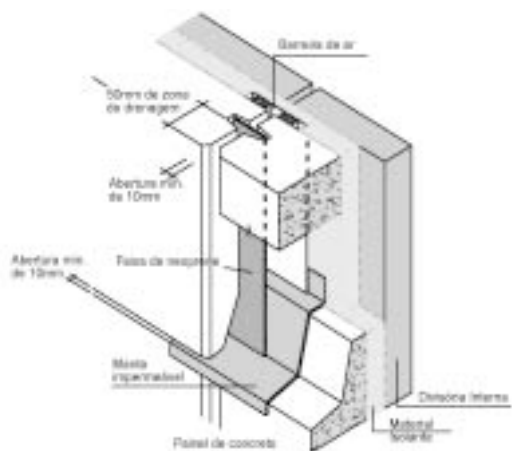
Detalhe de junta aberta e drenada com faixa vertical de neoprene (*baffle strip*).
